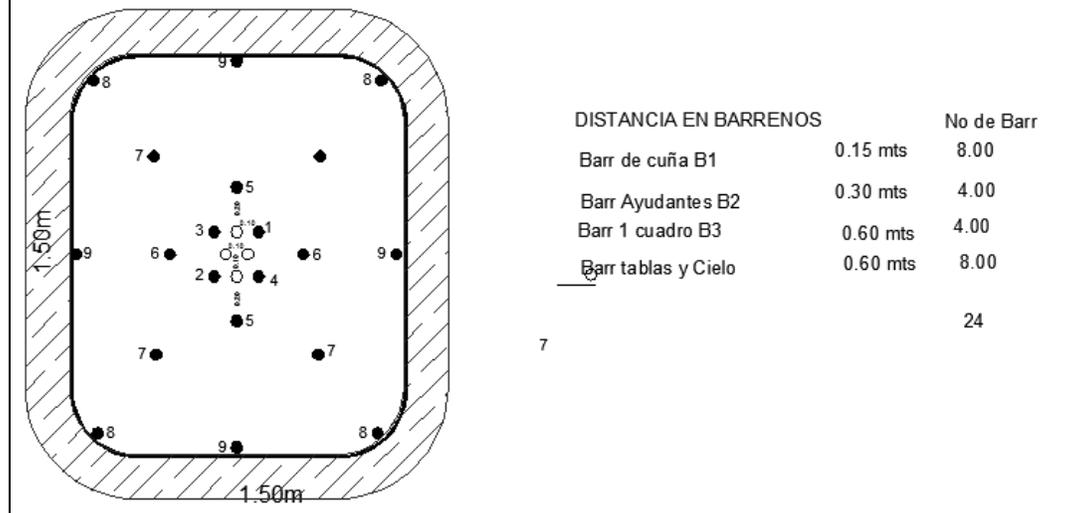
Accesos a Niveles existentes y áreas de explotación, detalles de barrenación rampas general, rebajes y contra pozos.
